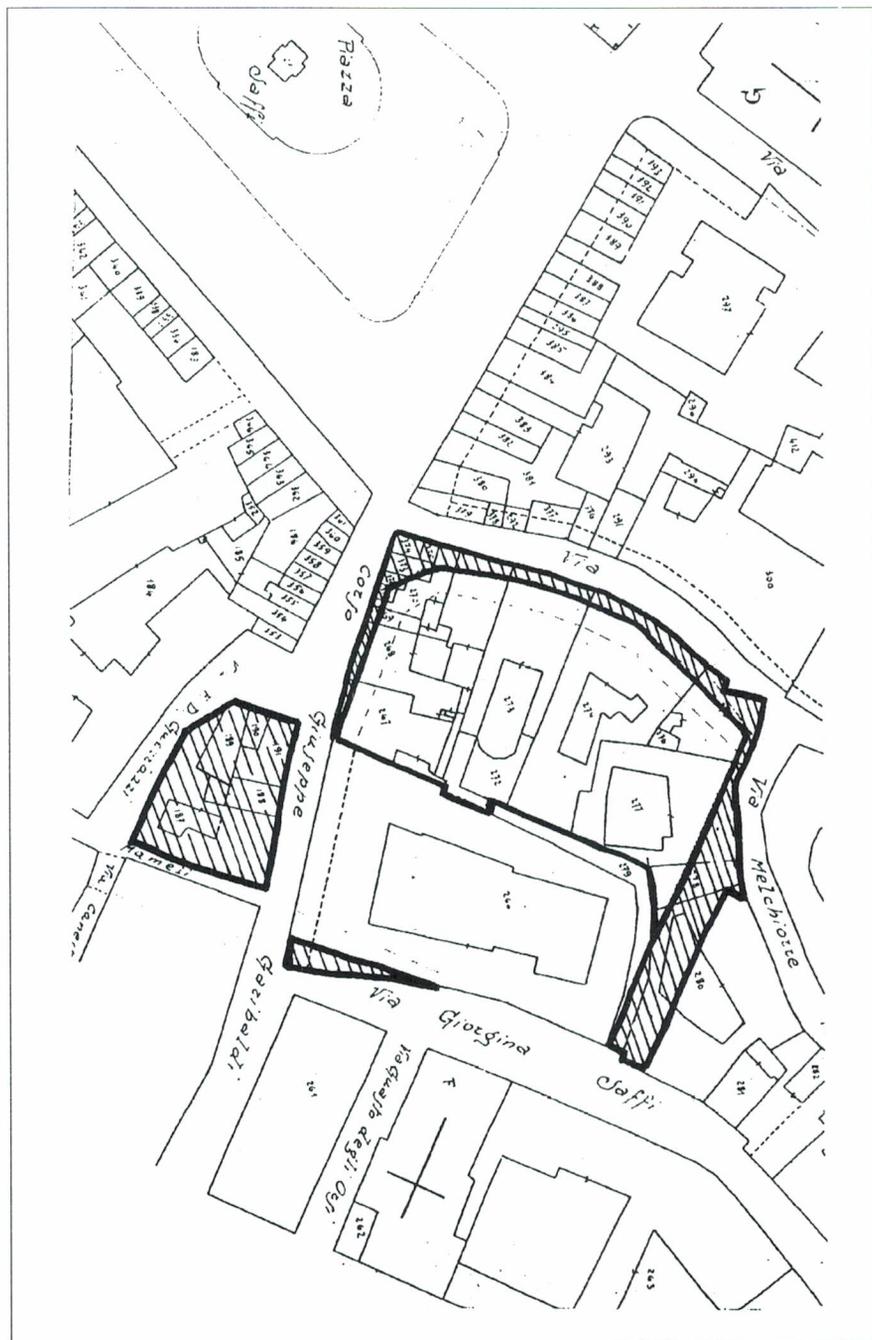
FORLÌ, Rialto Piazza. Stralcio di planimetria catastale con indicazione, a tratteggio, delle aree soggette a demolizione secondo le previsioni del Progetto del 1939
